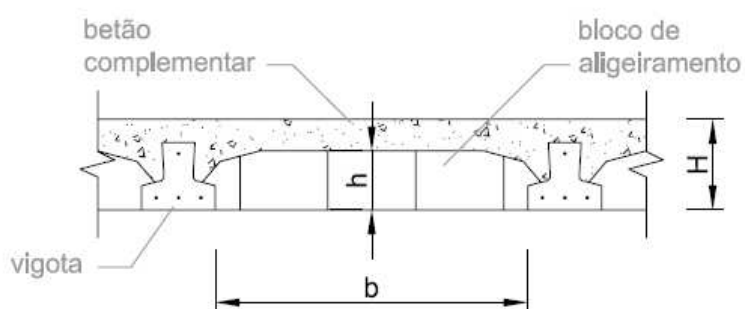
Esquema da solução laje aligeirada de vigotas pré-esforçadas S6 – corte transversal (vigota simples).
